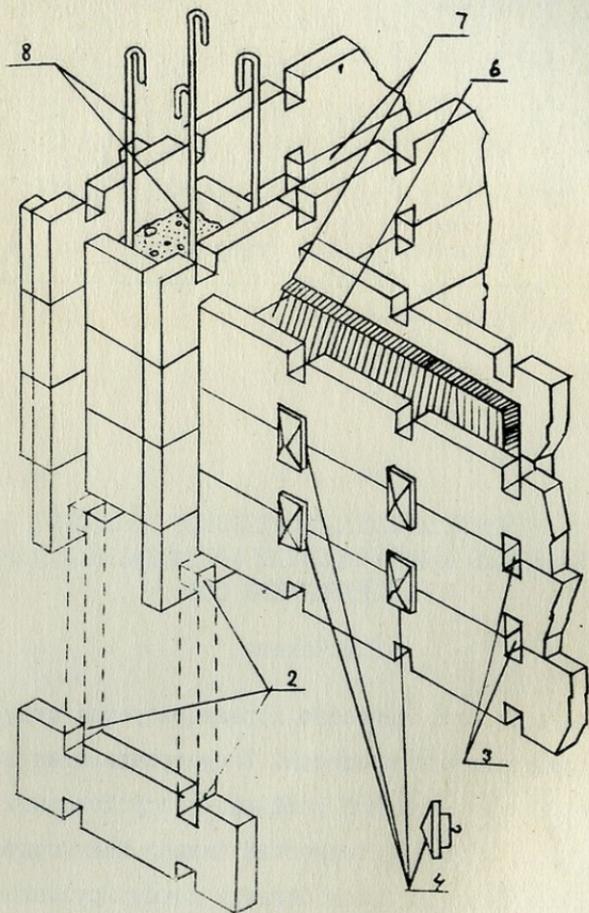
1-Универсальный строительный элемент, 2-прямоугольные углубления, 3-отверстия, имеющие размер и форму шейки, образованной на элементе углублениями, 4-декоративная вставка, 5-утепление, 6-воздушное пространство, 7-арматура железобетонного каркаса.
